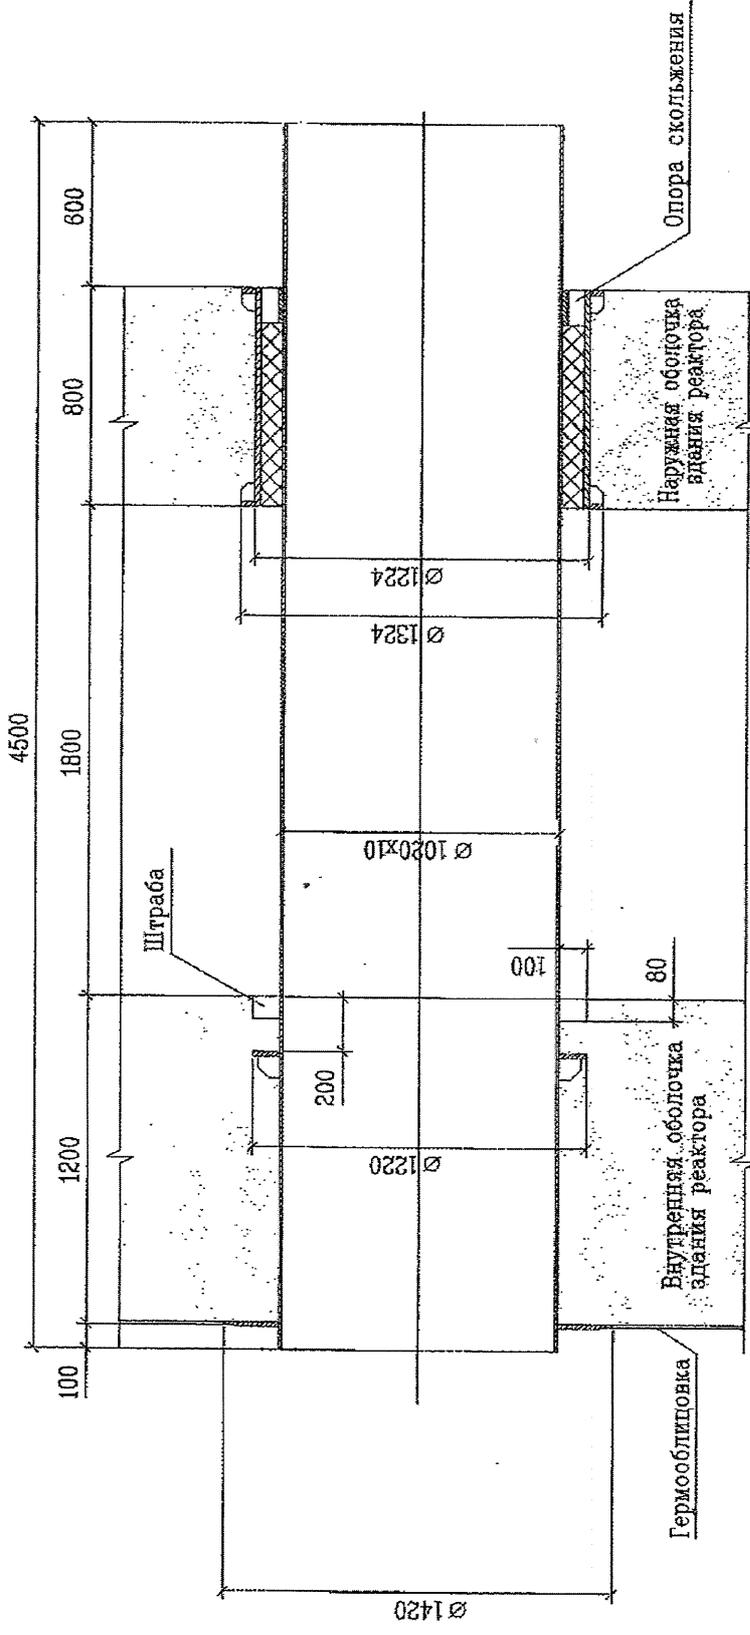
Габаритный чертеж герметичной проходки вентиляционных коробов
